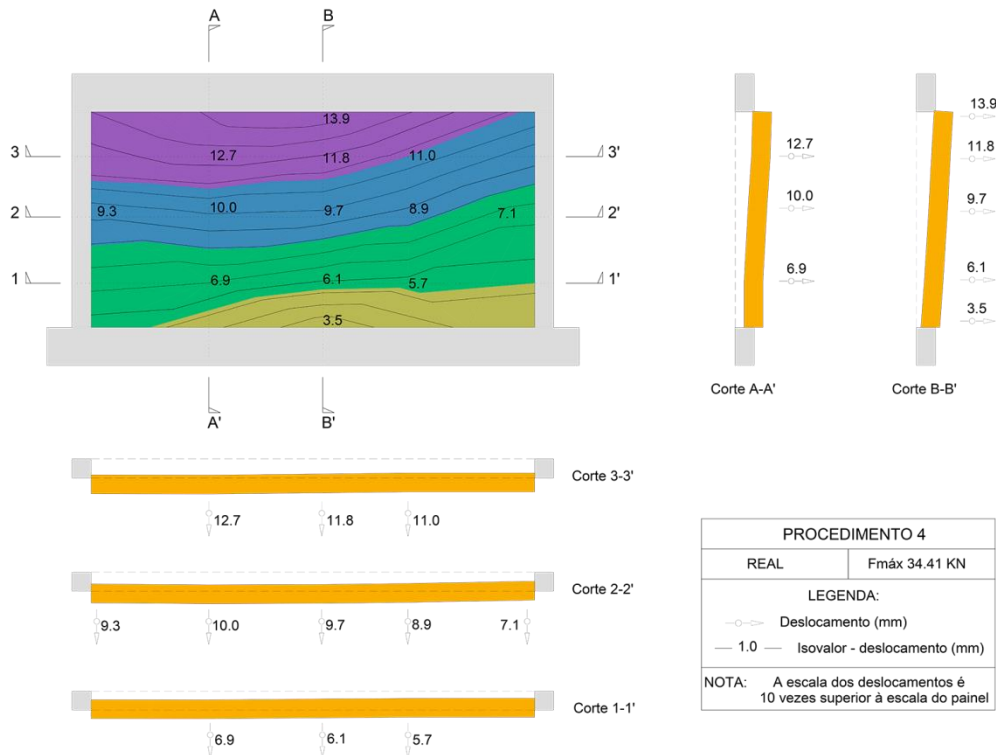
Isovalores da parede ensaiada - Procedimento 4. Ensaio fora do plano, Wall_RAR_01.
